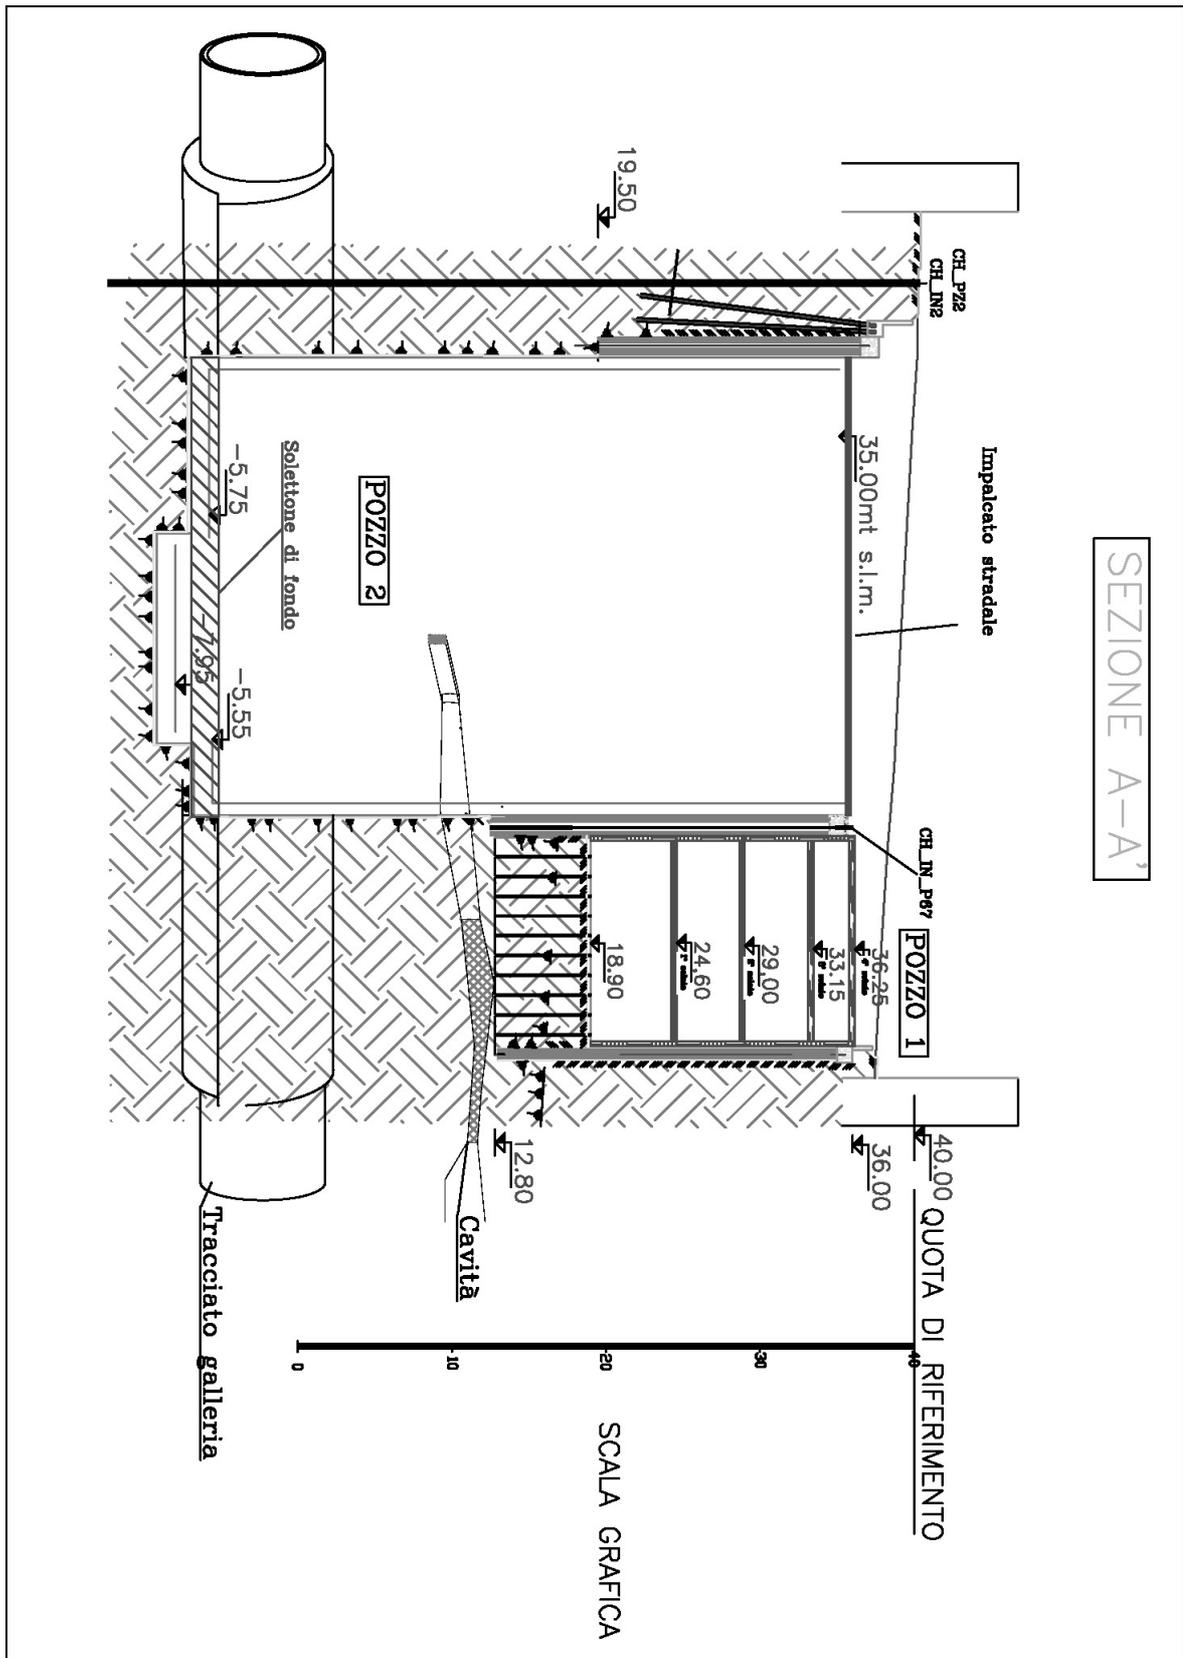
Sezione A-A' pozzo stazione, raffigurante la suddivisione in aree di lavoro.
